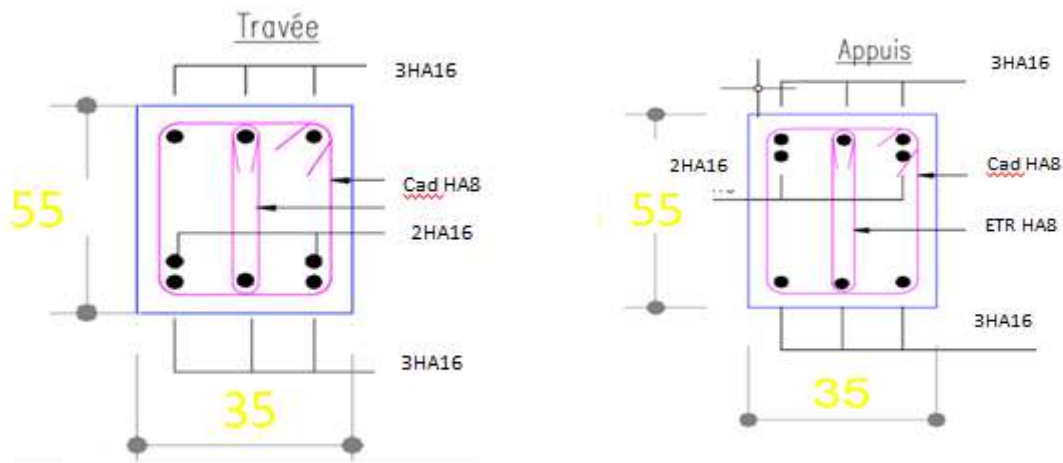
Schéma de ferrailage des poutres principales en BHP.
